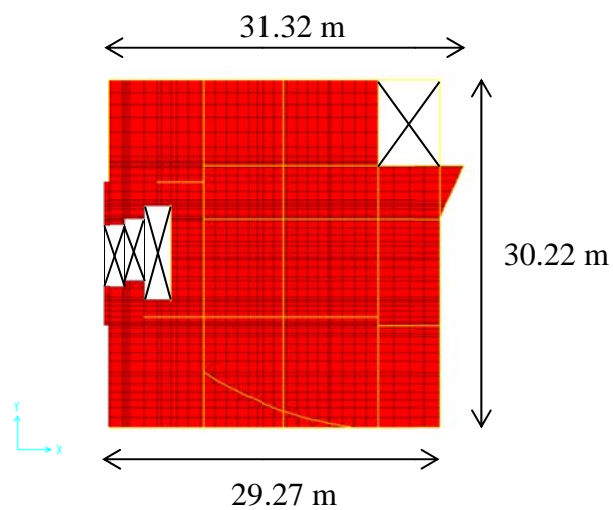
Dimensiones de la Planta Cielo Segundo Piso (S/E).
